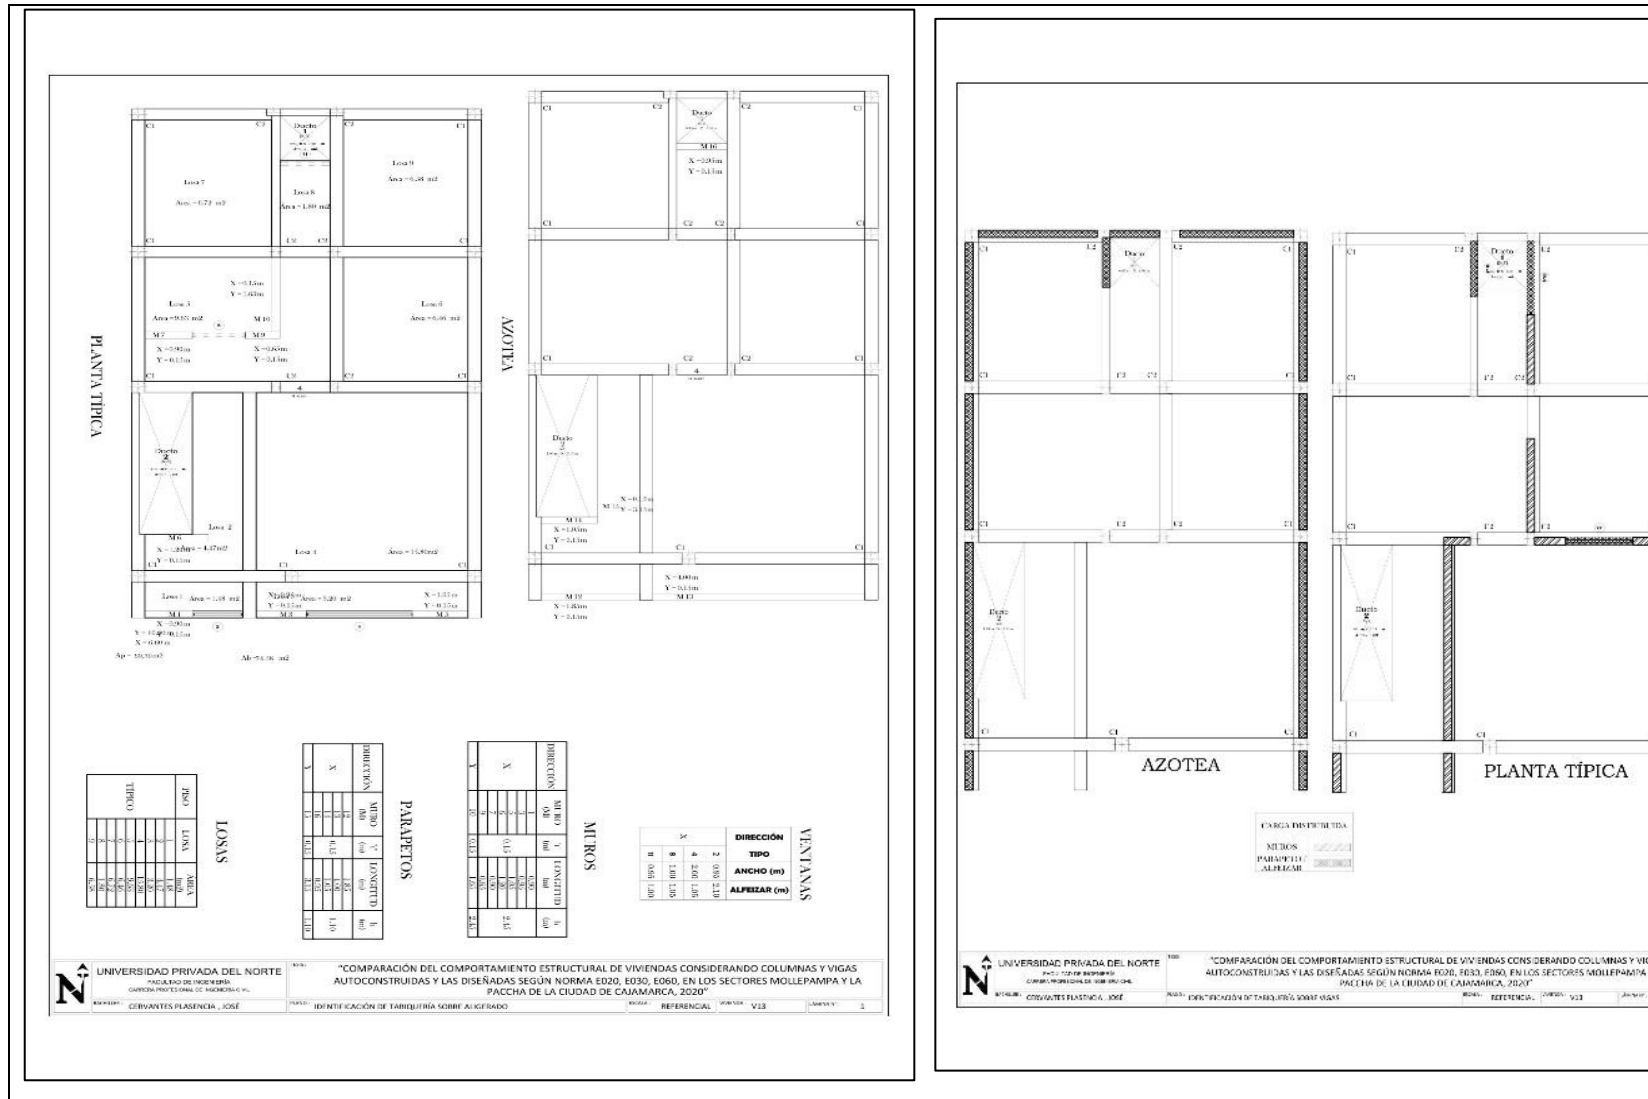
Tabiquería sobre losa aligerada y vigas vivienda 13
